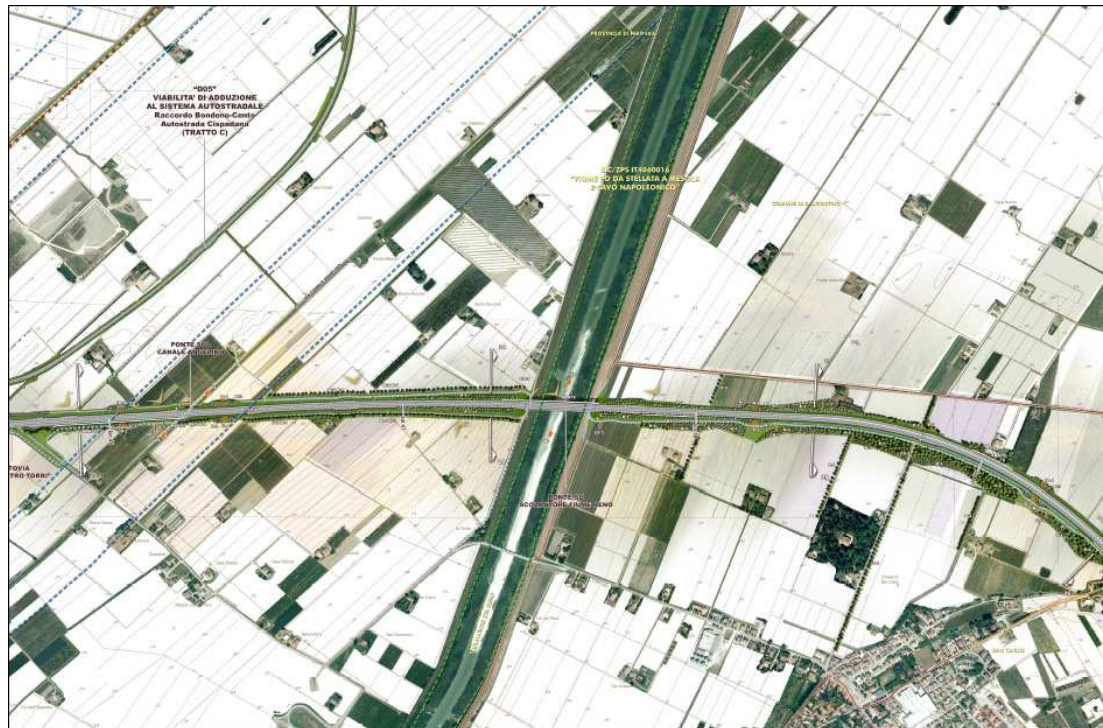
STRALCIO ELABORATO 3780_PD_0_000_0MA00_0_MA_P5_11 "PLANIMETRIA DI PROGETTO CON INDICAZIONE DEGLI
